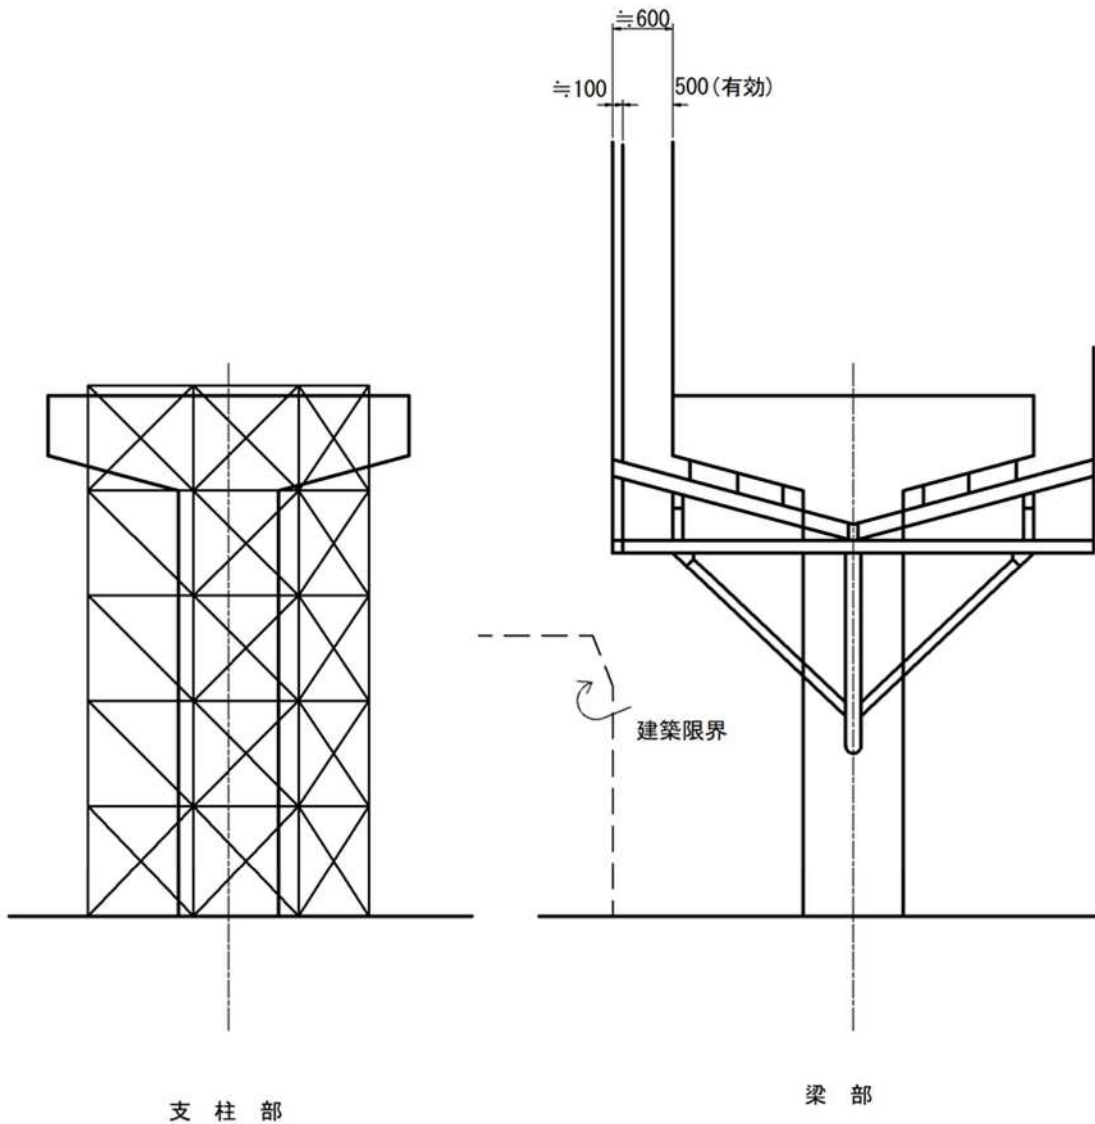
一般的なRC支柱の施工略図 (要領 3.3 図 3-57)
